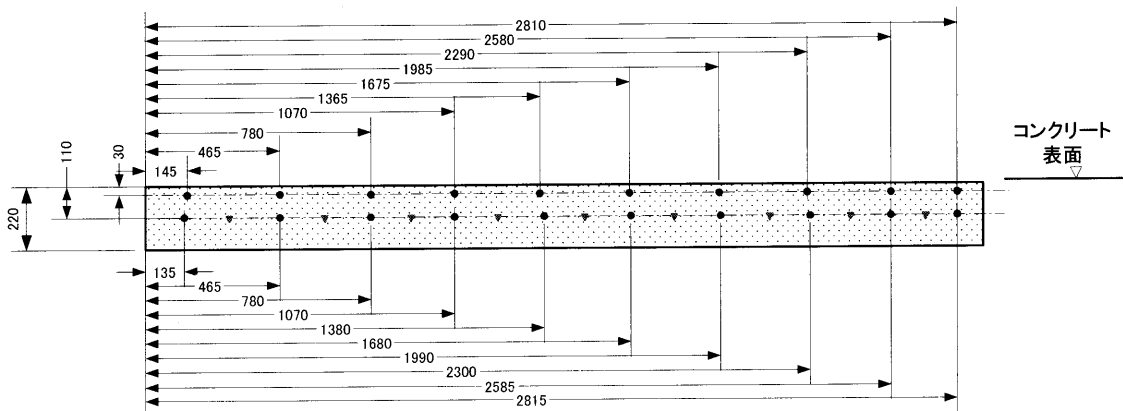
供試体② 側面 B 側 鉄筋位置図
